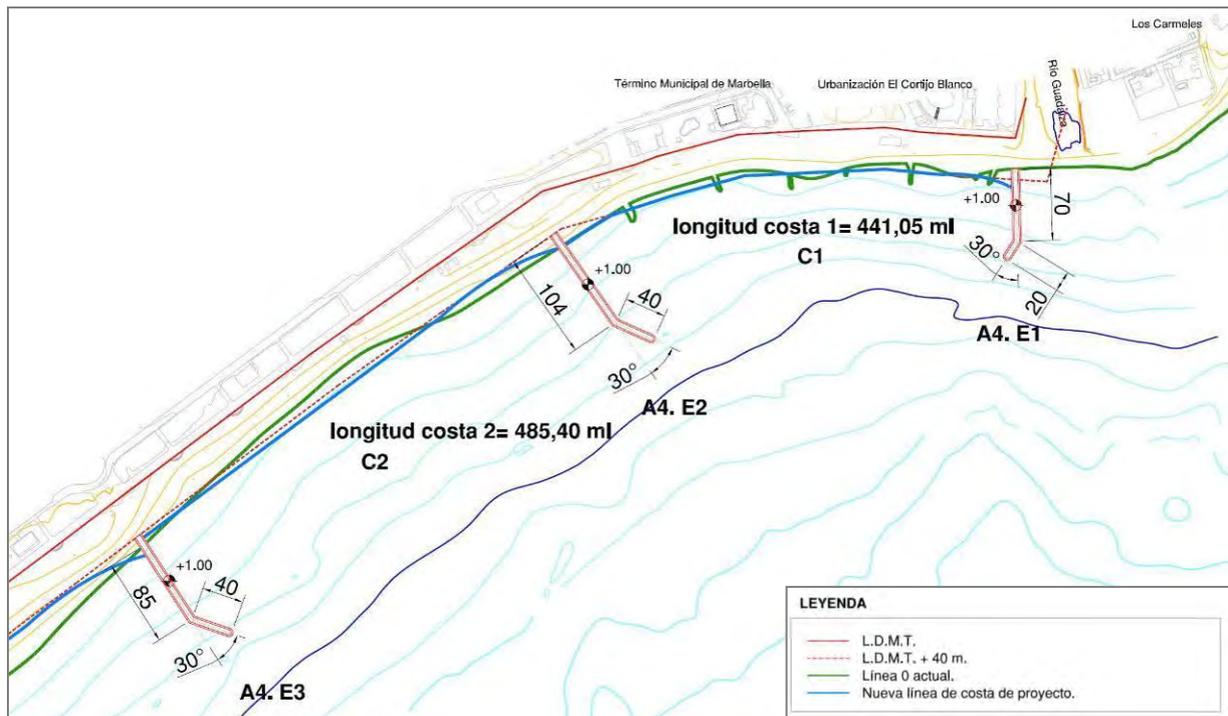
Planta Alternativa 4. Celdas C1-C2.
